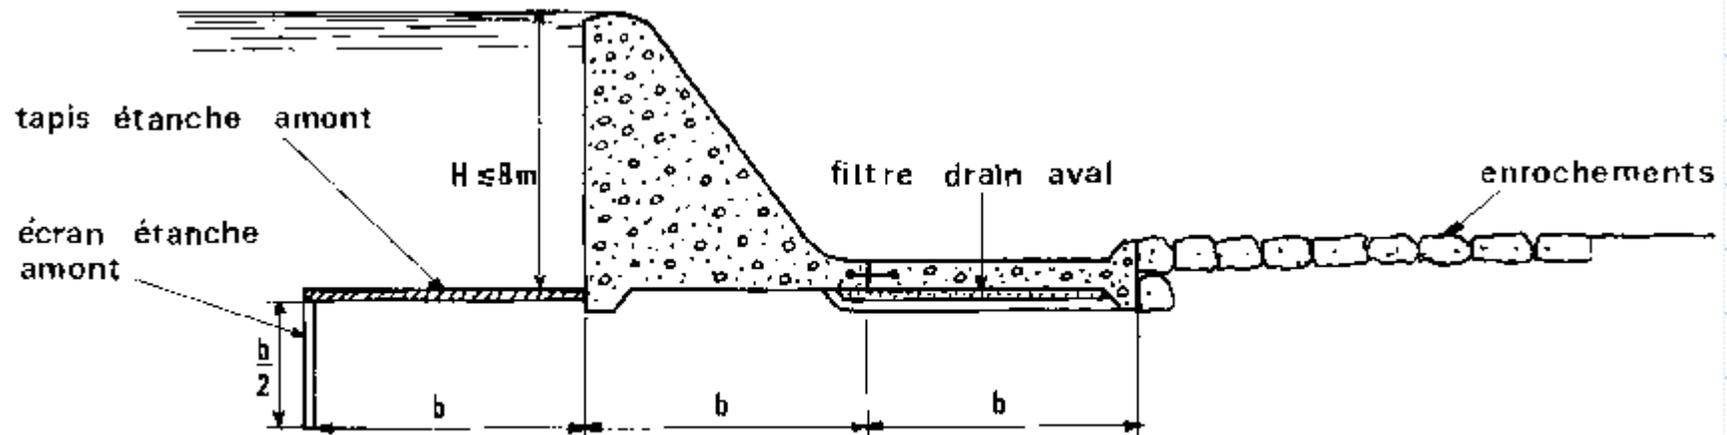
Schéma d'une coupe type de barrage poids en béton sur fondations meubles
